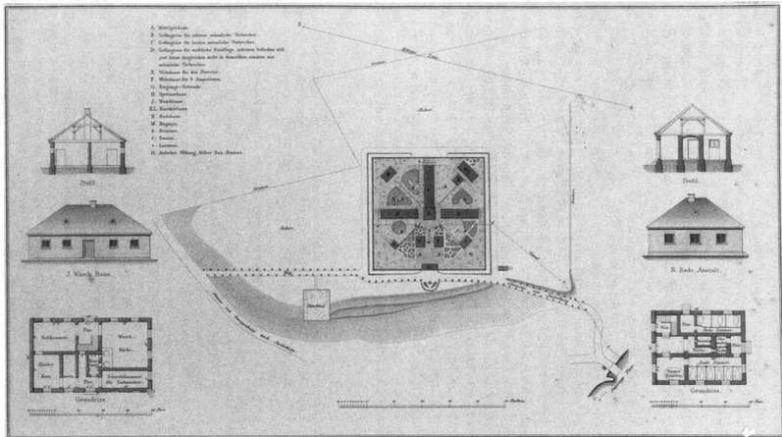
Strafanstalt in Insterburg. Lageplan, Grundrisse, Ansichten und Schnitte der Versorgungsbauten. Aus: [Nut01], S. 190.
